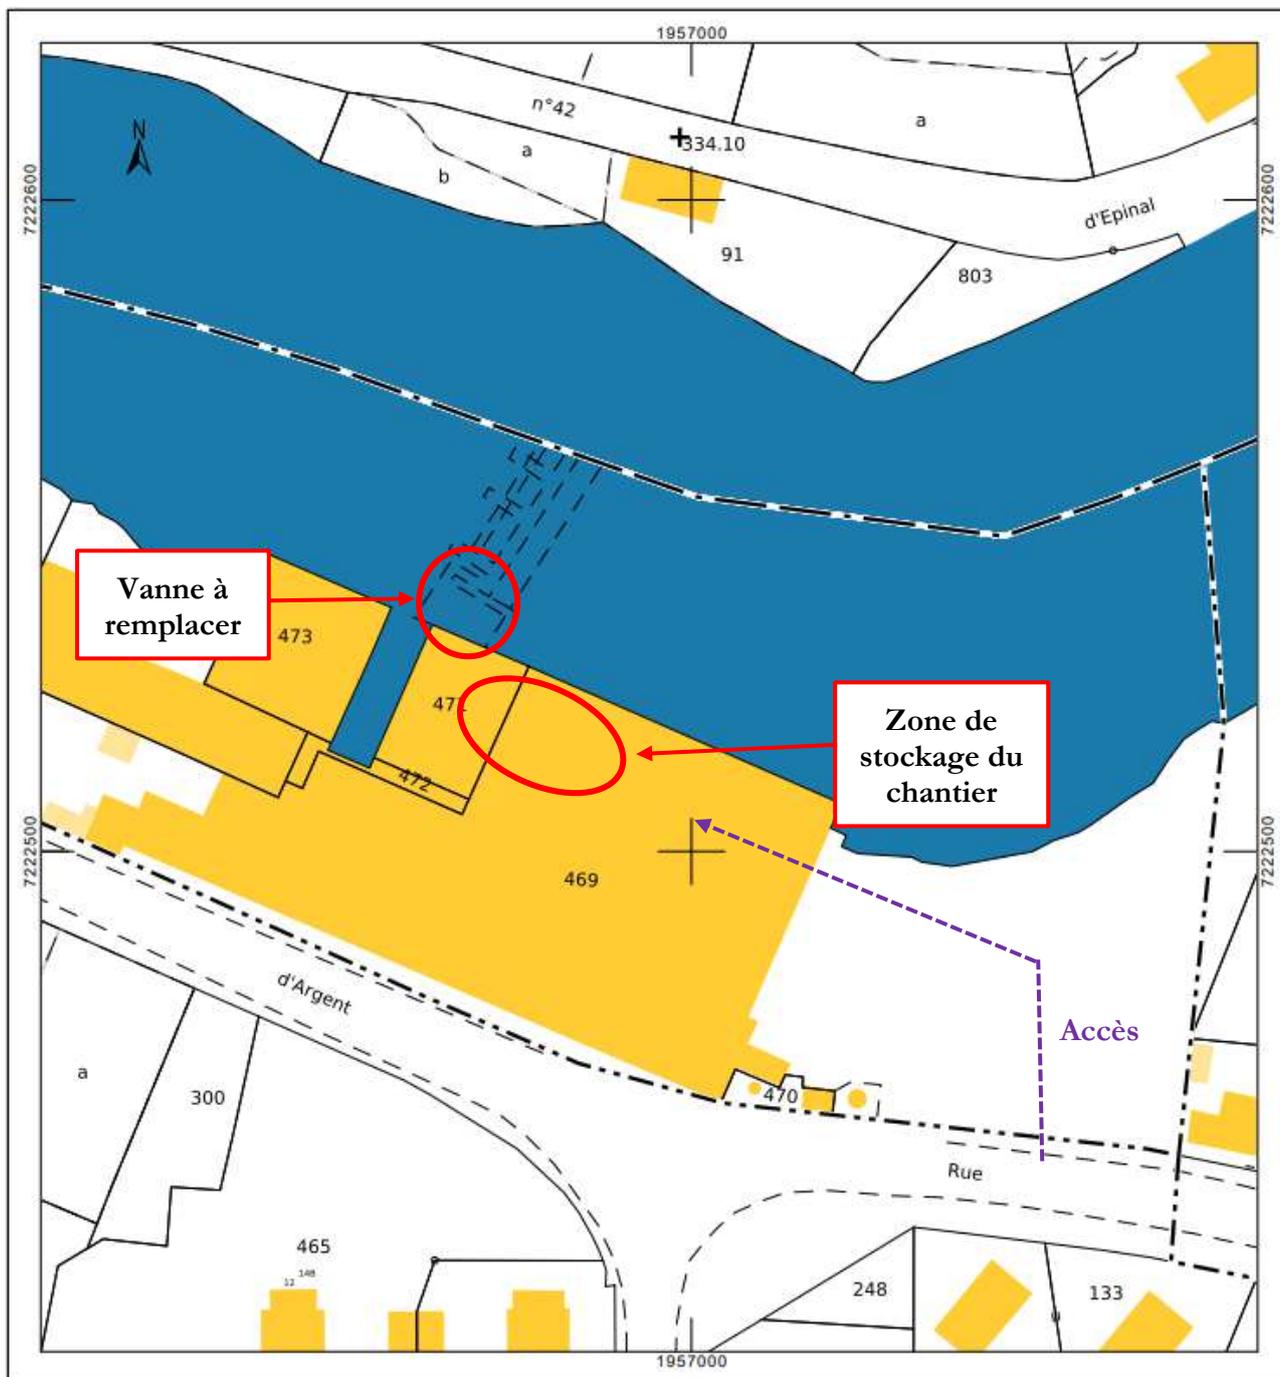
Extrait de plan cadastral (source : cadastre.gouv.fr)
